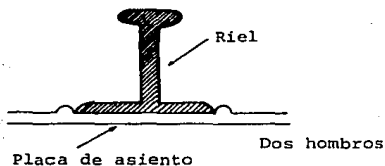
b Placa de asiento de caucho o Neupreno.
